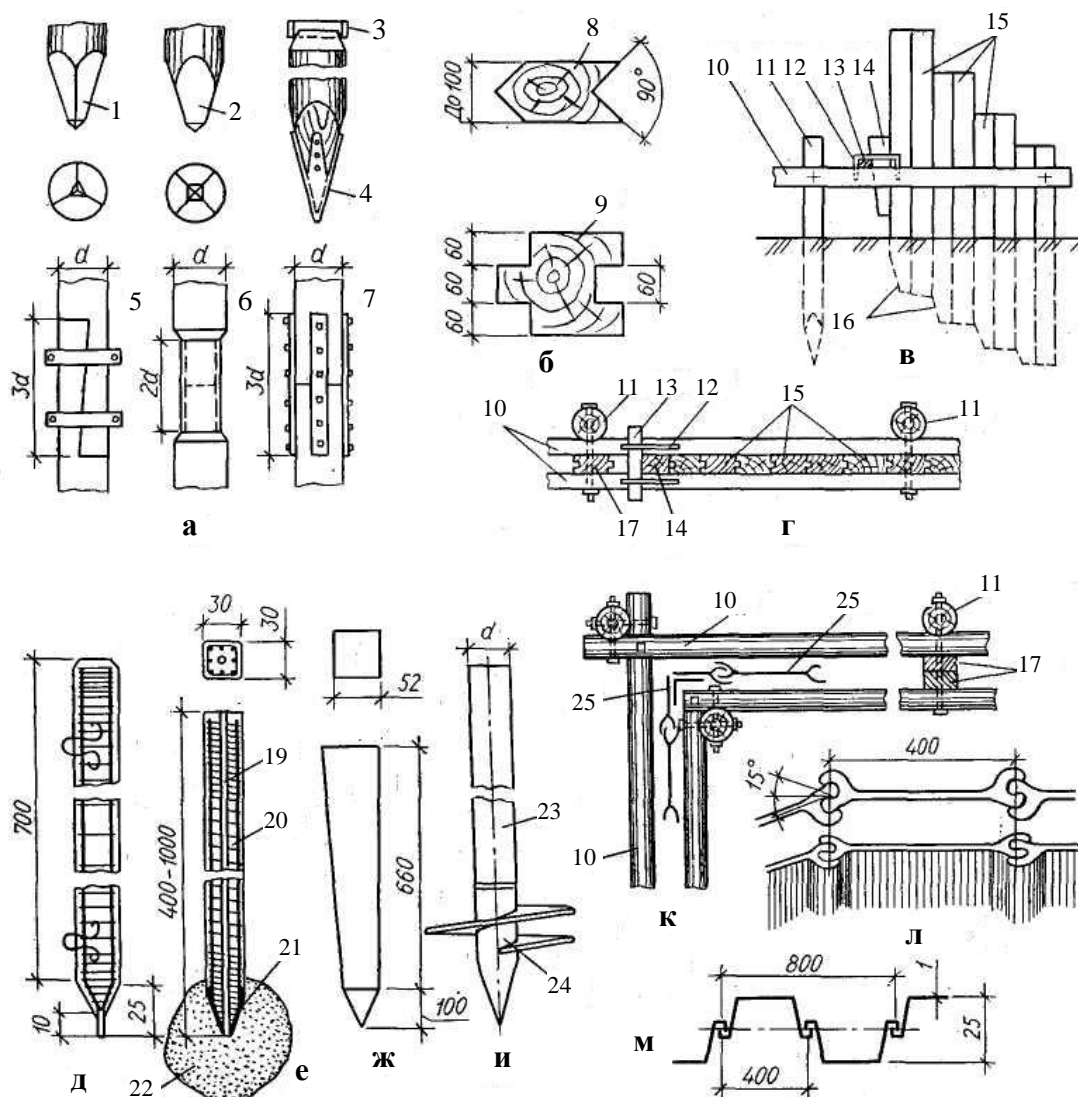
Види палі і шпунтових огорож: а – дерев’яні палі; б – перетини дерев’яних шпунтин; в – дерев’яна шпунтова стінка; г – дерев’яна шпунтована стінка, вигляд зверху; д – залізобетонна паля; е – забивна ін’єкційна паля; ж – прямокутна пірамідальна паля; и – гвинтова паля; к – сталеві шпунтові стінки; л – плоский сталевий шпунт; м – профіль коритного сталевих шпунт; 1 – тригранне затесування; 2 – чотиригранне затесування; 3 – сталевий бугель; 4 – сталеве наконечня; 5 – стик у півдерева на хомутах; 6 – стик у півдерева за допомогою сталеві труби; 7 – стик у торець на сталевих накладках; 8 – шпунтина з дошки з трикутним пазом і гребенем; 9 – шпунтина з бруса з квадратною щілиною і гребенем; 10 – дерев’яні напрямні зачіпи; 11 – маякові палі; 12 – скоби; 13 – упертя; 14 – клин; 15 – пакети дерев’яних шпунтин; 16 – скосини при затісванні шпунтини; 17 – прокладки; 18 – посилення голови палі арматурою у вигляді хомутів; 19 – ін’єкційна труба; 20 – паля; 21 – сталевий башмак; 22 – закріплюваний ґрунт; 23 – стрижень палі; 24 – гвинтове наконечня; 25 – сталевий шпунт
